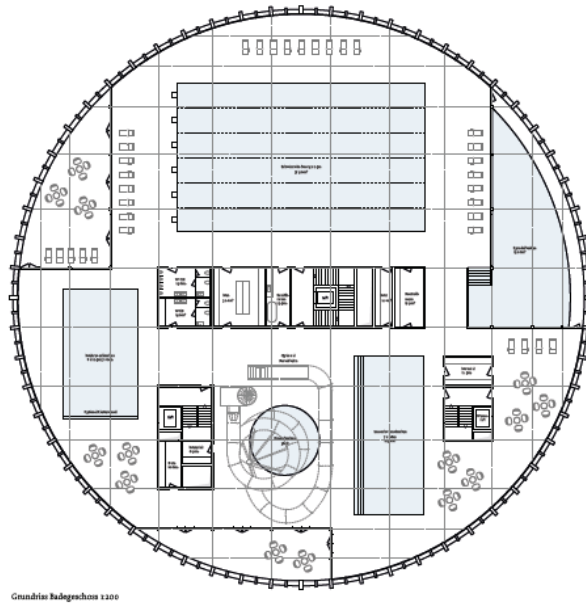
Grundriss Badegeschoss (ohne Masstab)
